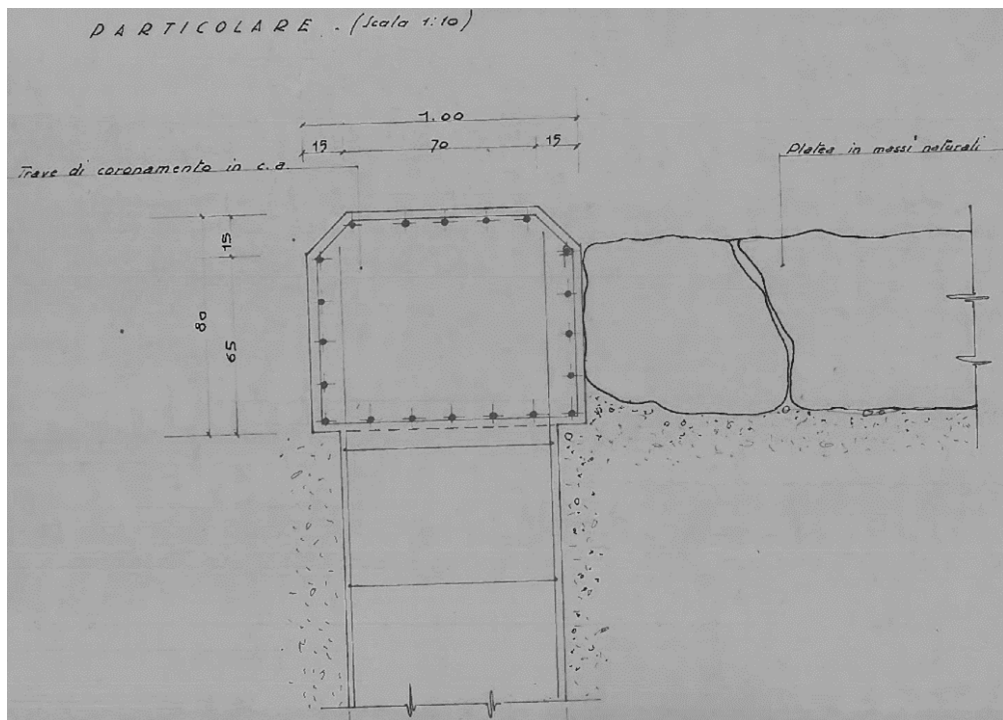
Particolare trave di coronamento, elaborato 4676/273
